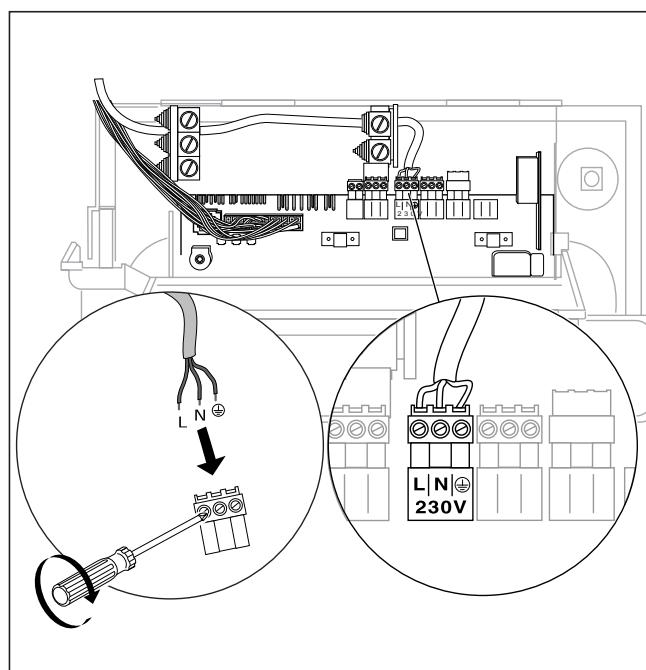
Raccordement de la conduite d'alimentation du secteur
